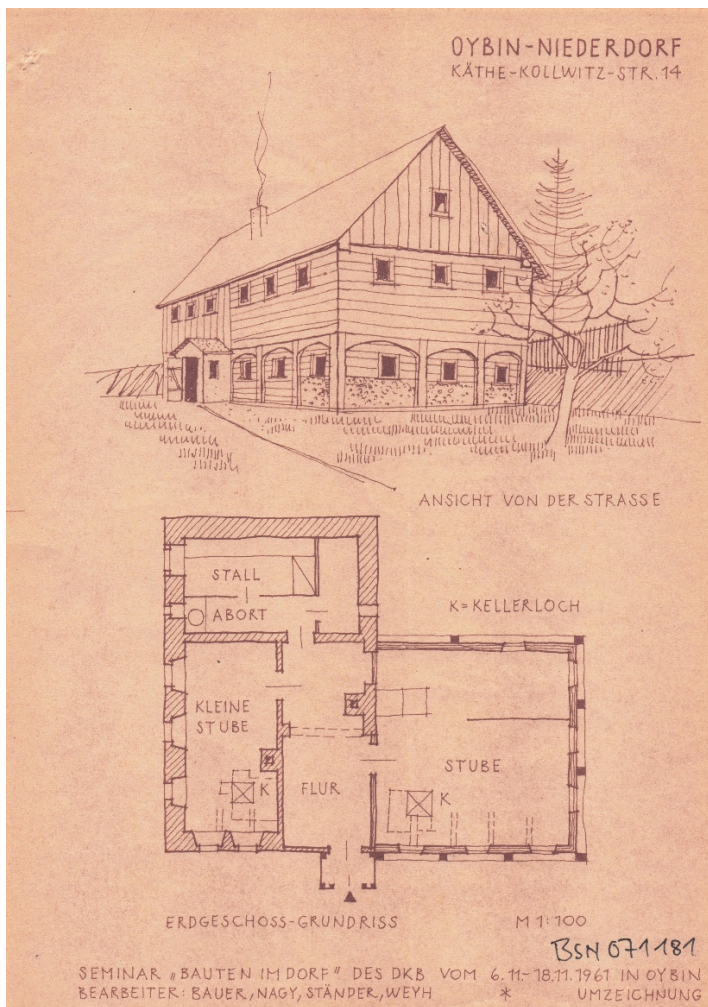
Bauer/Nagy/Ständer/Weyh: Gebäudeplan Käthe-Kollwitz-Straße 14 in Oybin-Niederdorf (Oybin 1961. ISGV-BSNR: 071181. Alle Rechte vorbehalten.).
